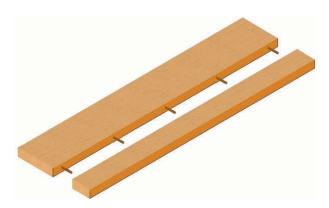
32: Encolado de piezas de madera para el armado de las huellas de una escalera.
